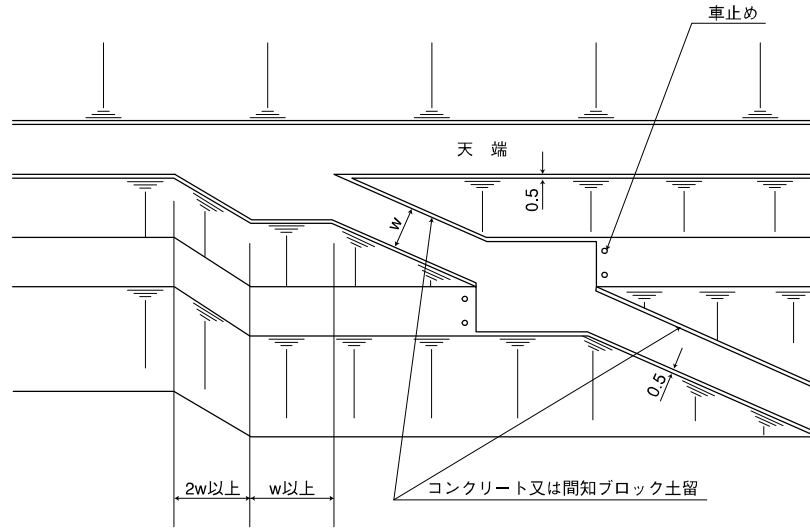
(1) 坂路工詳細図(小段がある場合)
